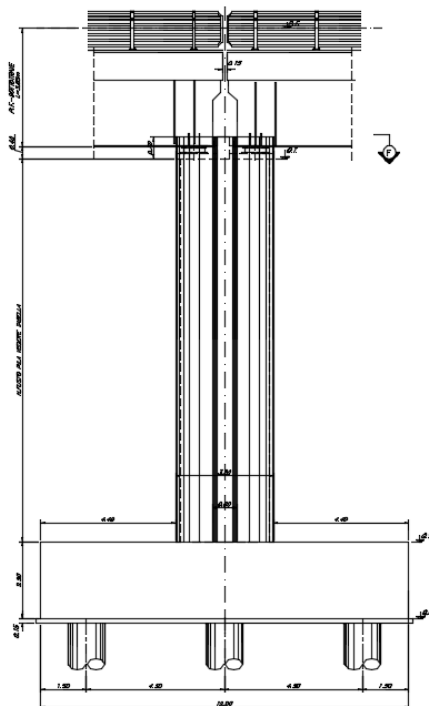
Prospetto Pila P01 – P06 – P07 -sezione longitudinale
